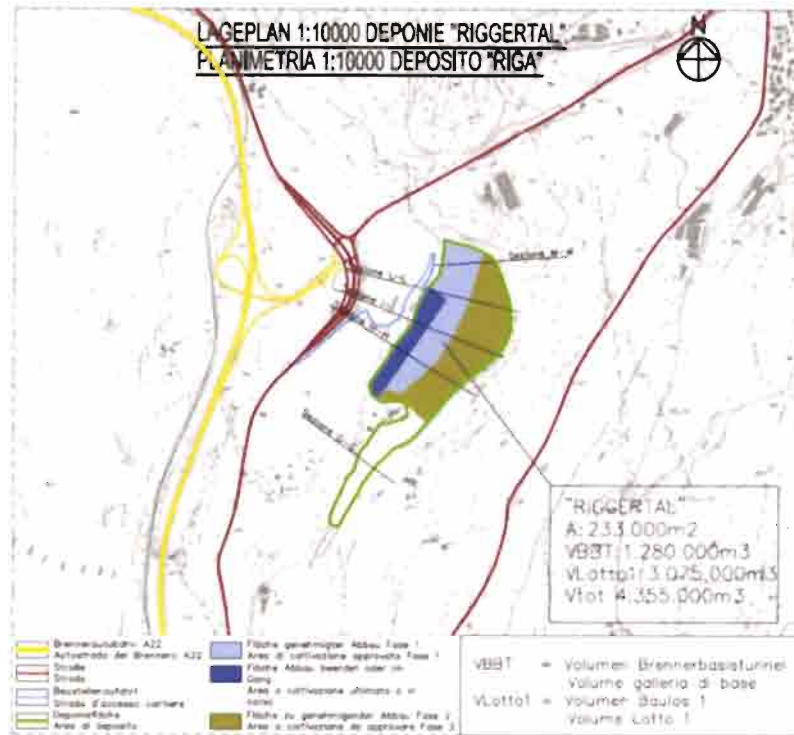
Progetto preliminare - Sito Val Riga: Planimetria finale recepite prescrizioni MATT 2004
